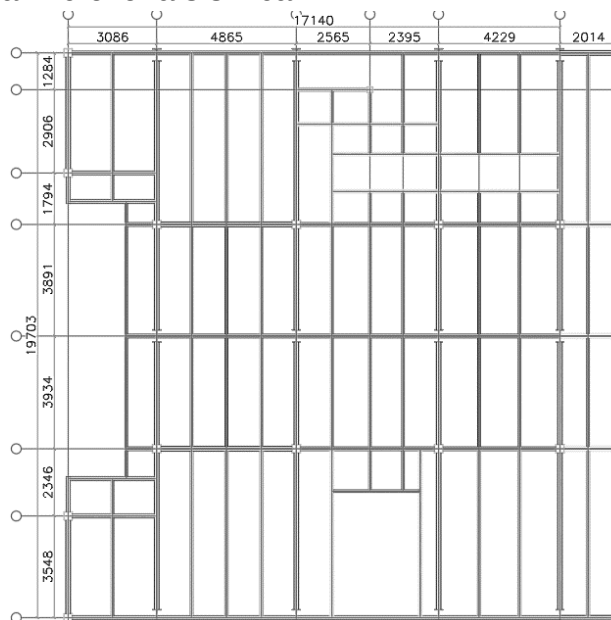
Vista en planta edificio de 3 pisos (piso tipo).
